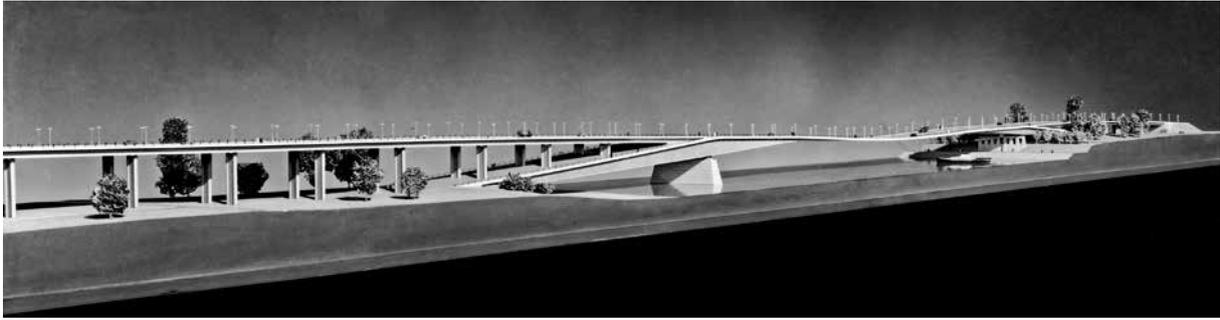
Wettbewerbsentwurf Zoobrücke Köln, Modelfoto
